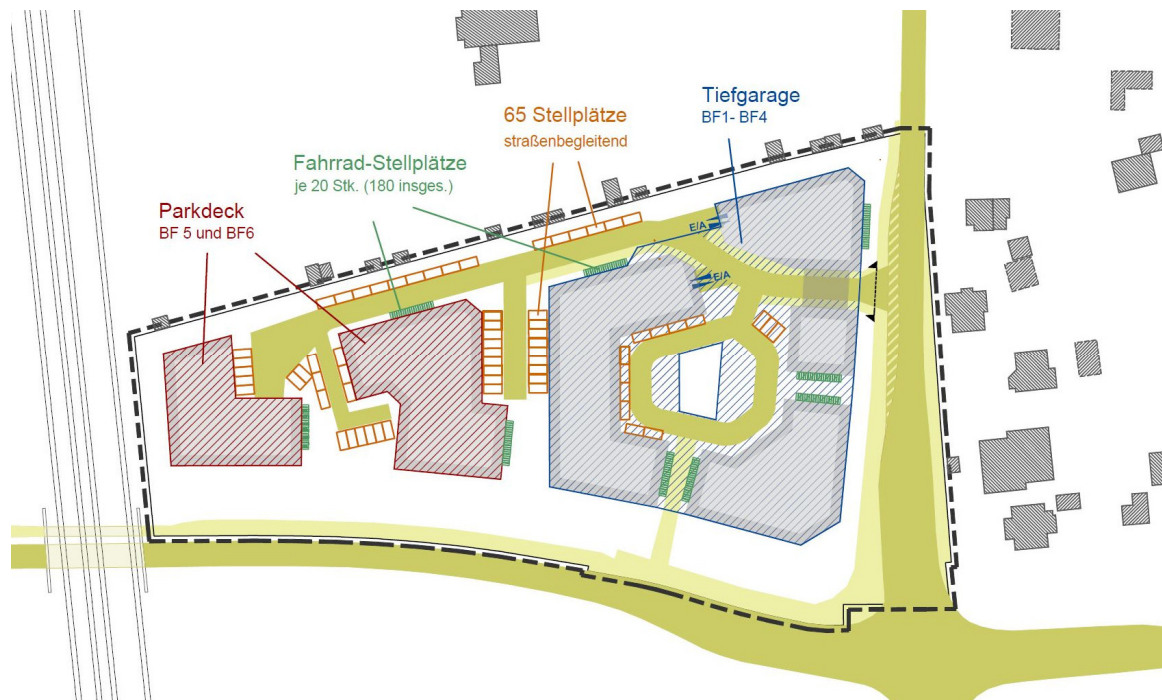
Darstellung möglicher Stellplatzflächen im Plangebiet
